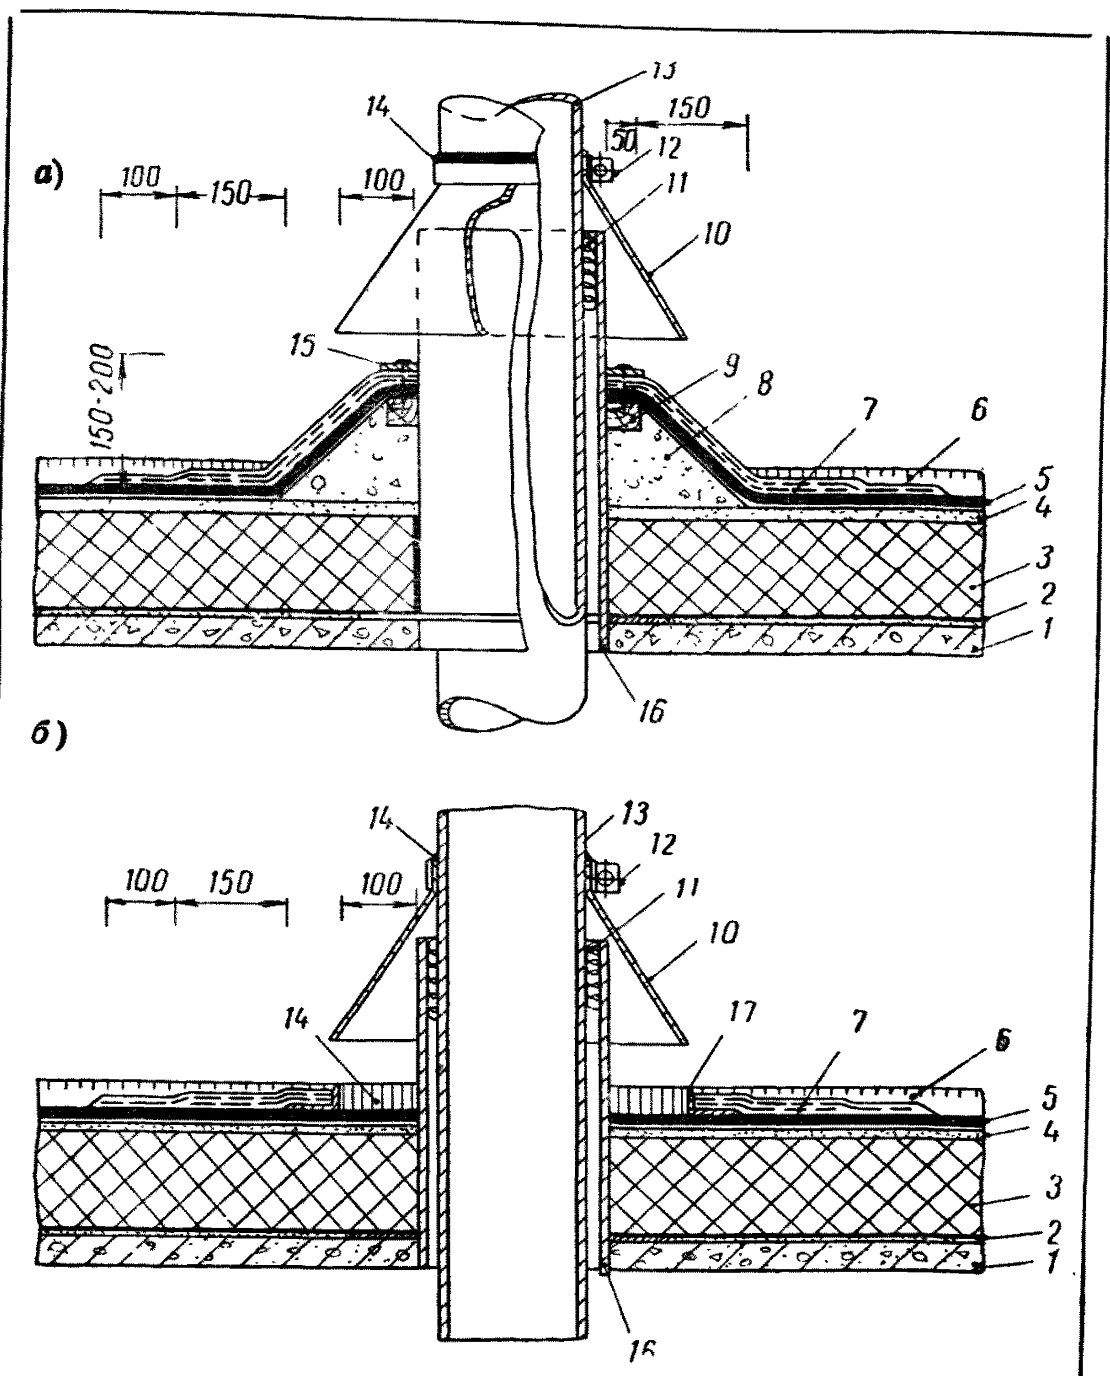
Примеры решения пропуска труб через мастичную кровлю
